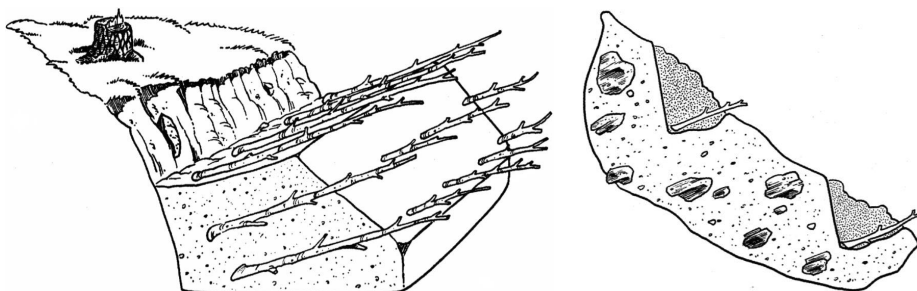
Kistevegg kan gjerne kombineres med beplantning av stiklinger, slik som på figurene. Vestre: Under installasjon. Høyre: Nyinstallert. (Bilder hentet: hvv. [venstre](#) og [høyre](#))
